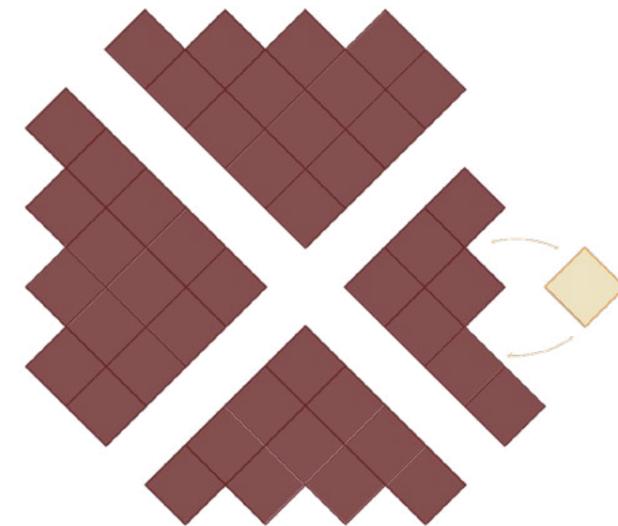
Esquema modular en planta del Centraal Beheer. Fuente: Autoría propia
